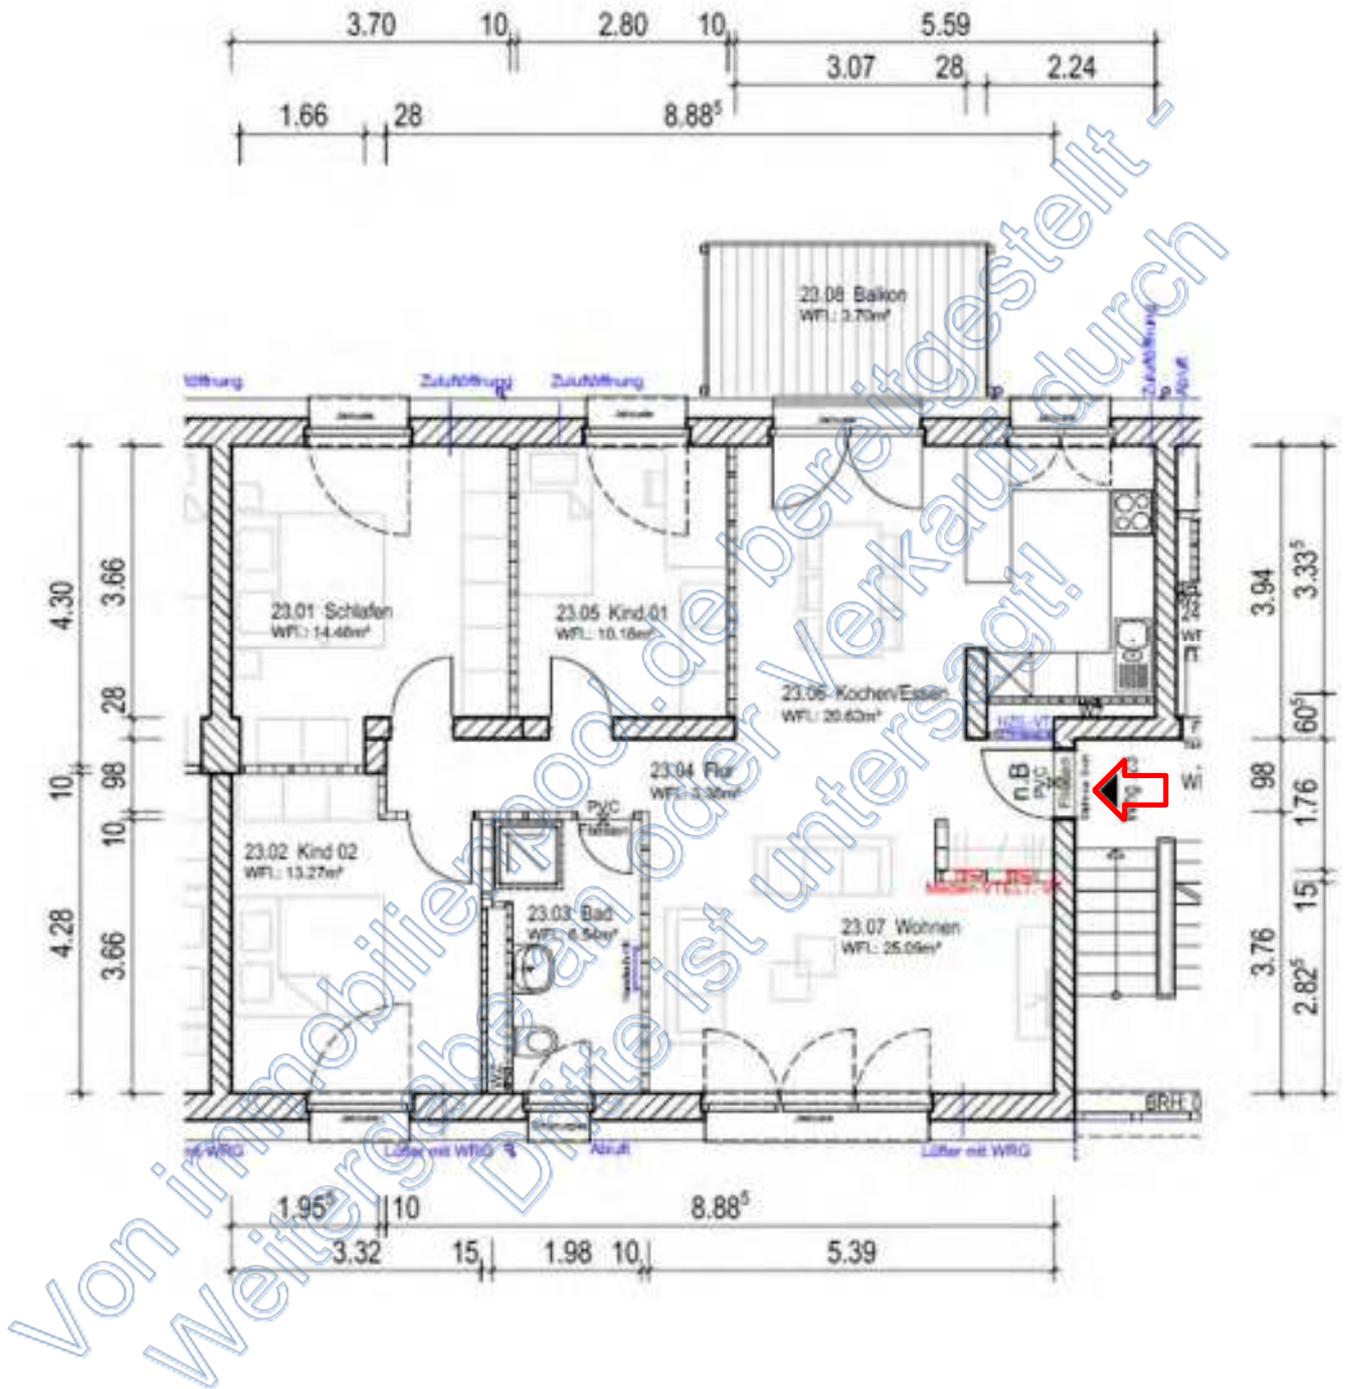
Grundrissplan Wohnung Nr. 137
